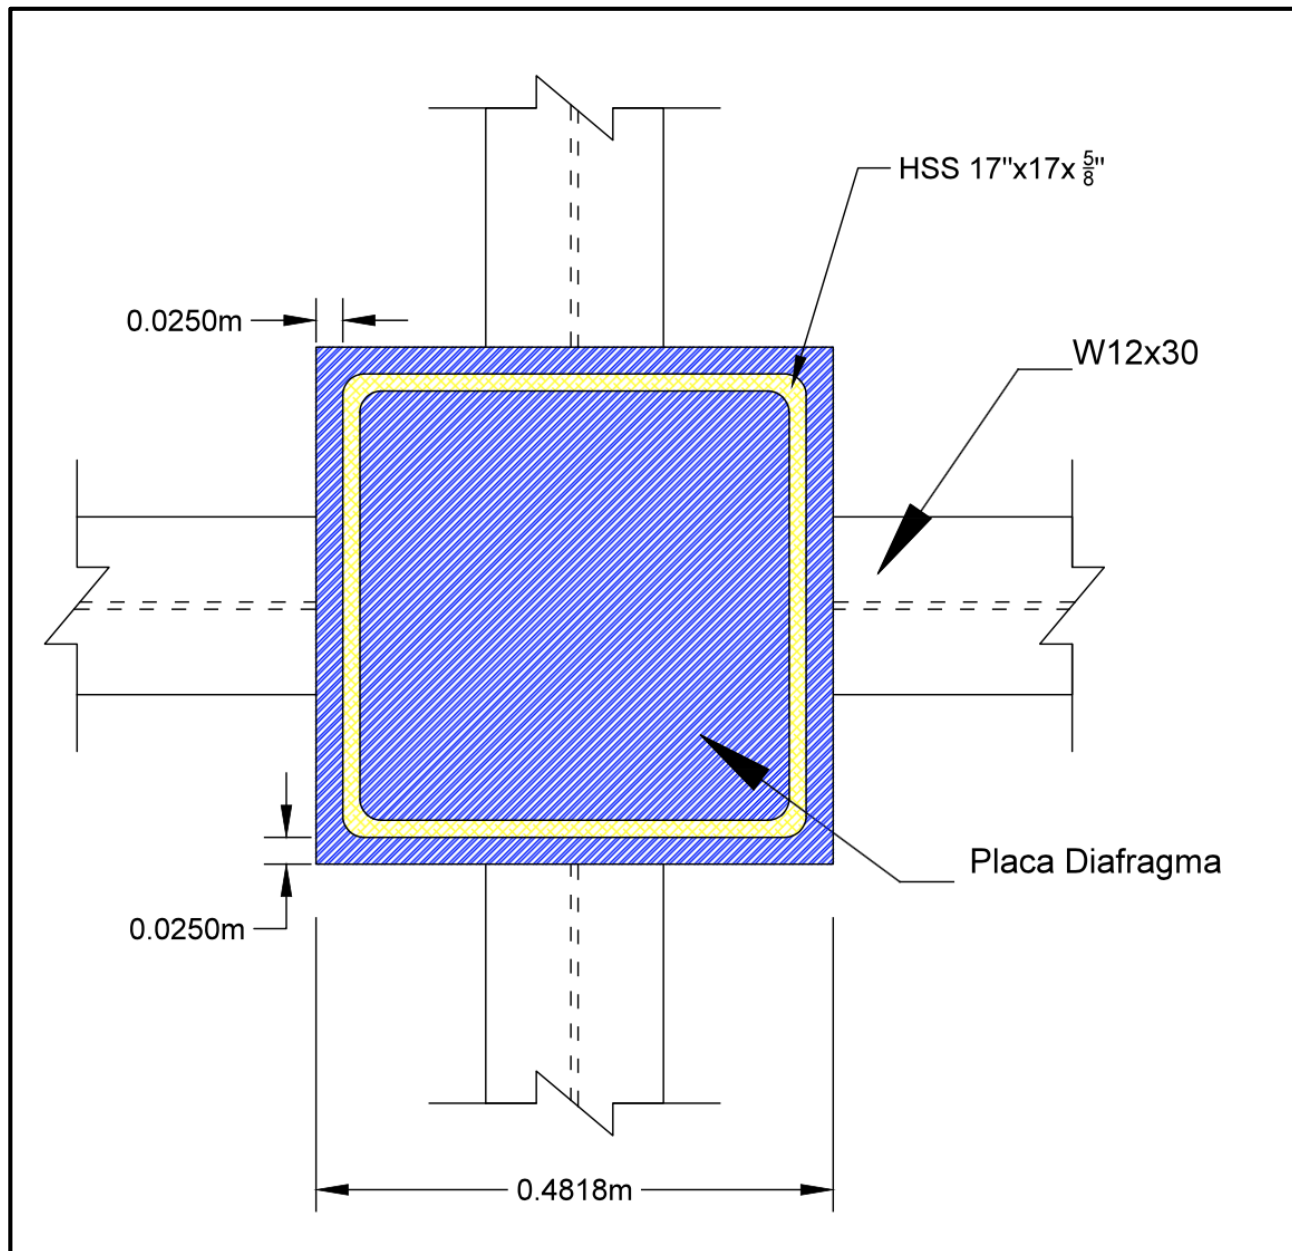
Vista en planta de la conexión y sus dimensiones. (Elaborado por el autor, 2017)
